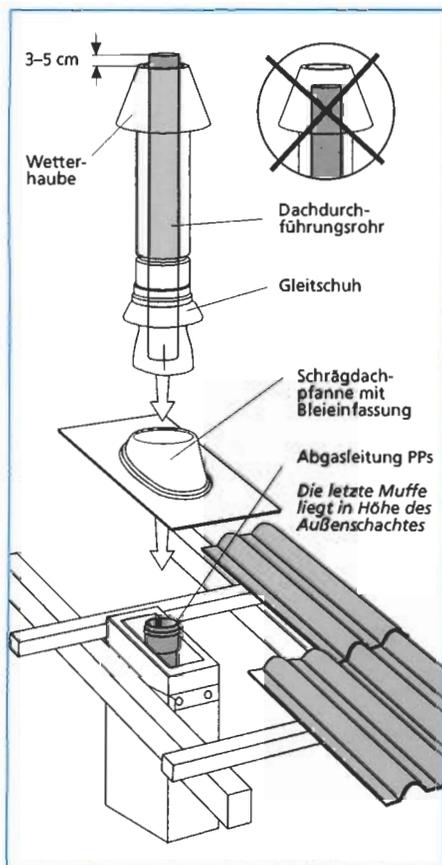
Befestigung der Schachtelemente gemäß Zulassung / Prüfzeugnis an brennbaren Baustoffen. Der Fertigschacht wird Unterkante der Dachabdeckung schräg abgeschnitten und durch die Schrägdachpfanne verschlossen.
